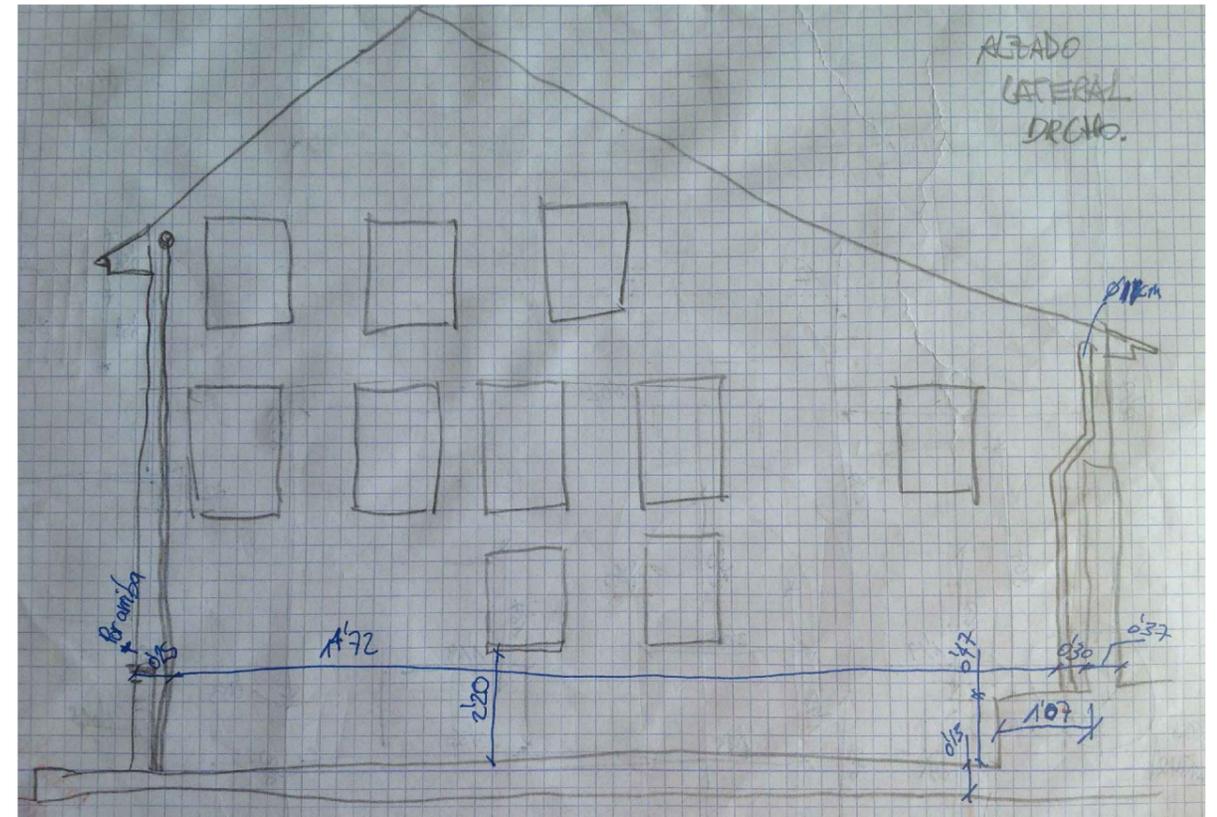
Fachada lateral derecha (NE). 2014. Fuente: elaboración propia.
